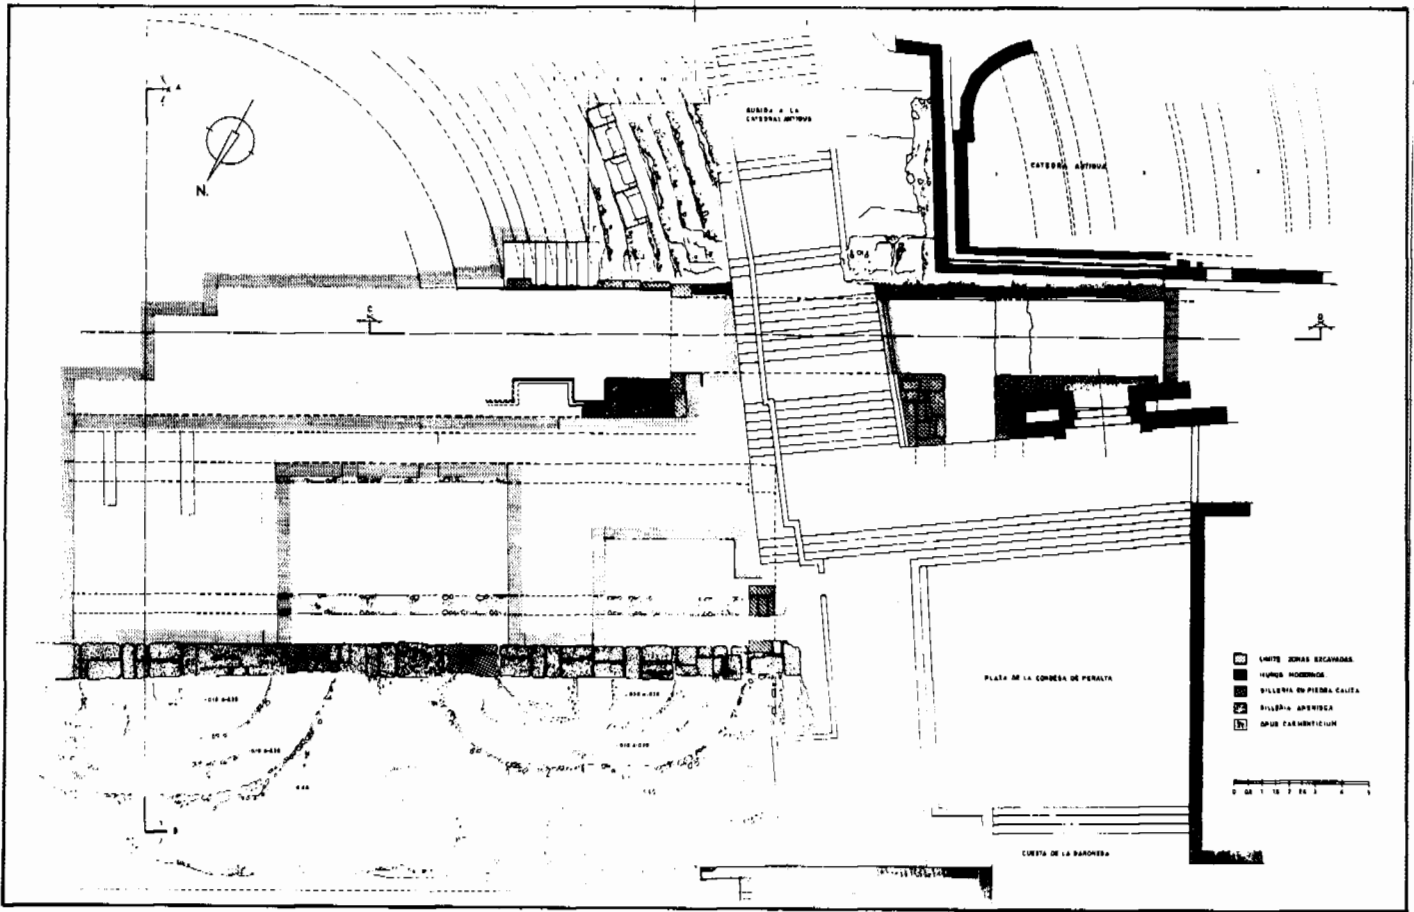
Sectores excavados en la zona baja. Planta esquemática de conjunto sobre planimetría de excavación.
